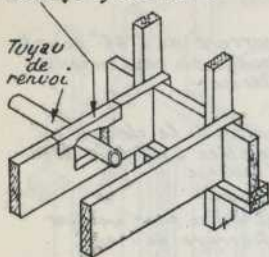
Entaillage de solive pour passage de tuyaux.
